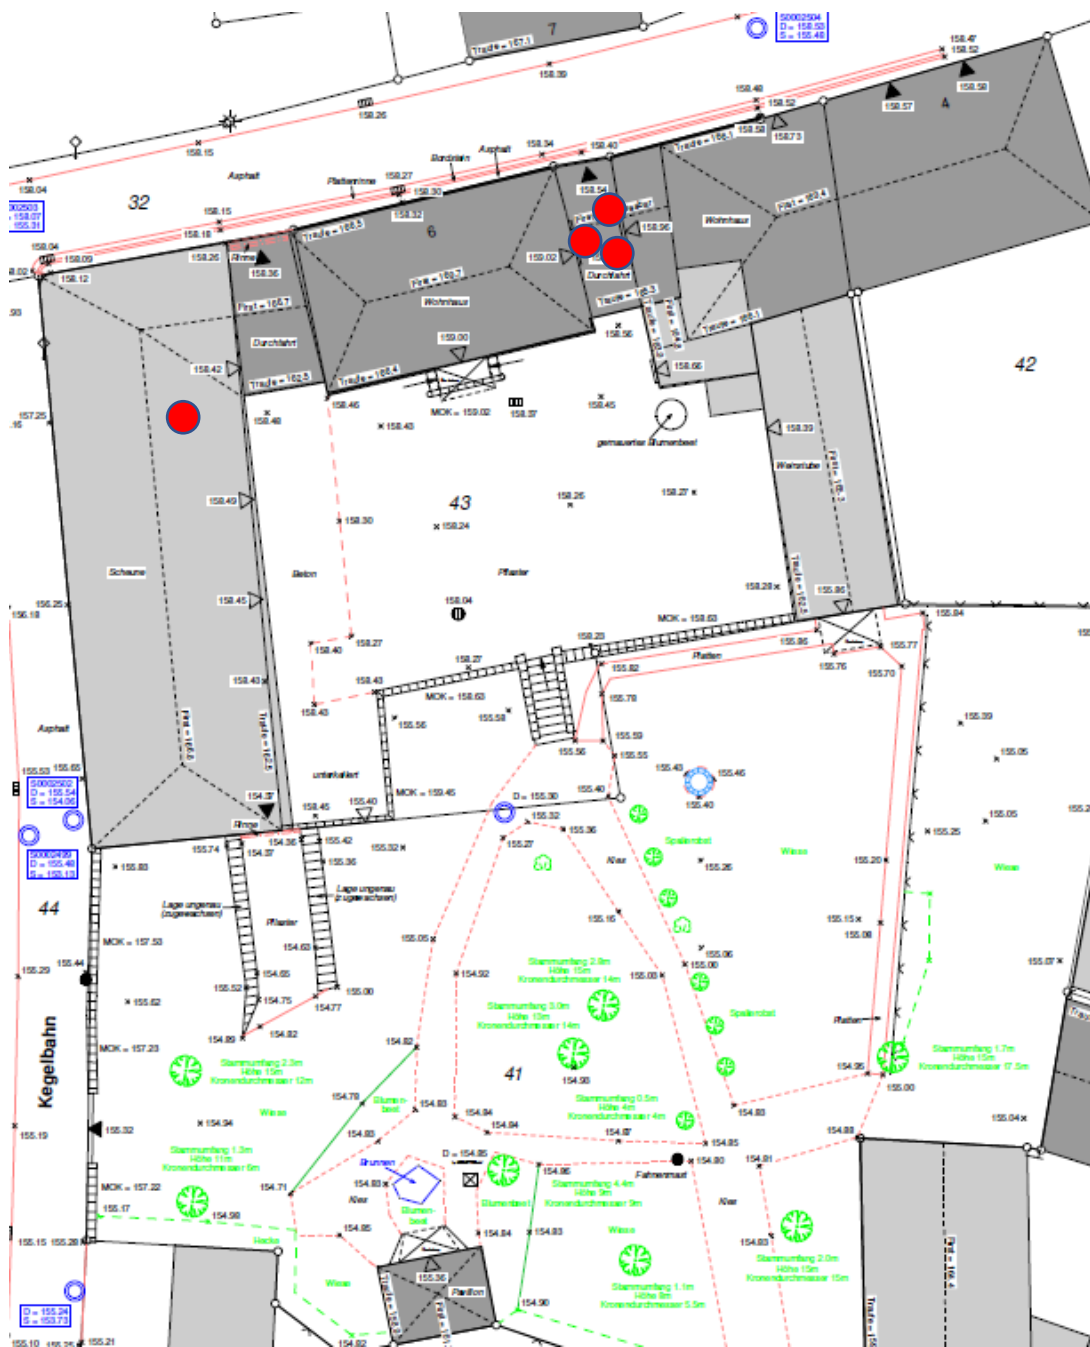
Verortung der gefundenen Rauchschwalbennester (rote Kreise) [Quelle Bauherr]
